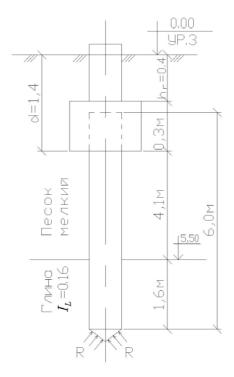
Схема размещения сваи-стойки в грунтах основания
